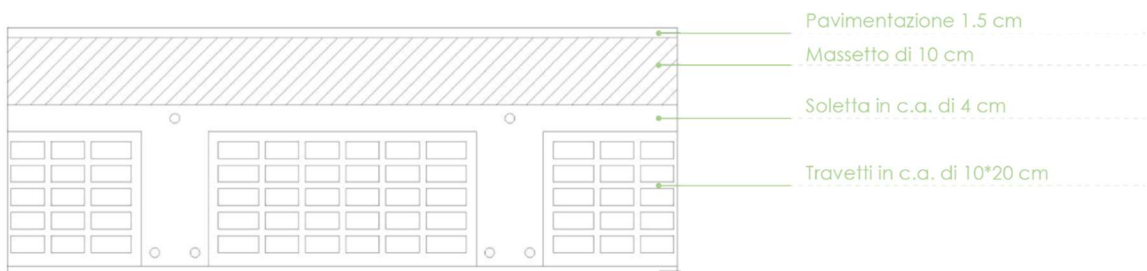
, Rappresentazione del solaio di copertura e del solaio di piano
